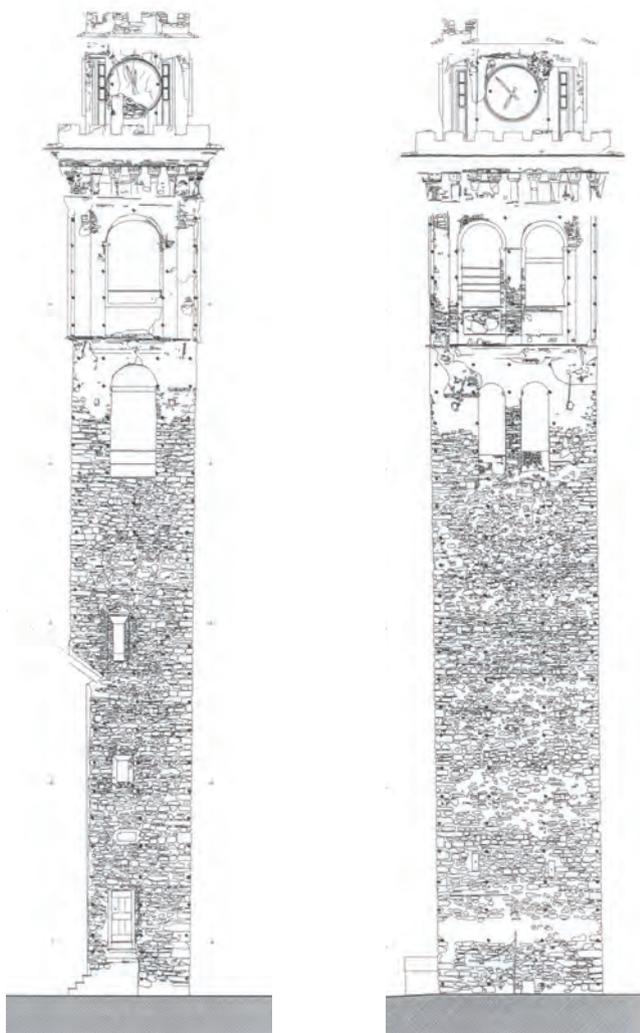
Restituzione fotogrammetrica del prospetto est e nord della torre
